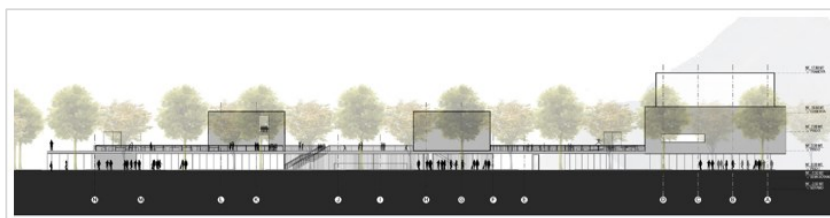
Corte arquitectónica A – A'' Colegio El Ensueño – Bogotá.
